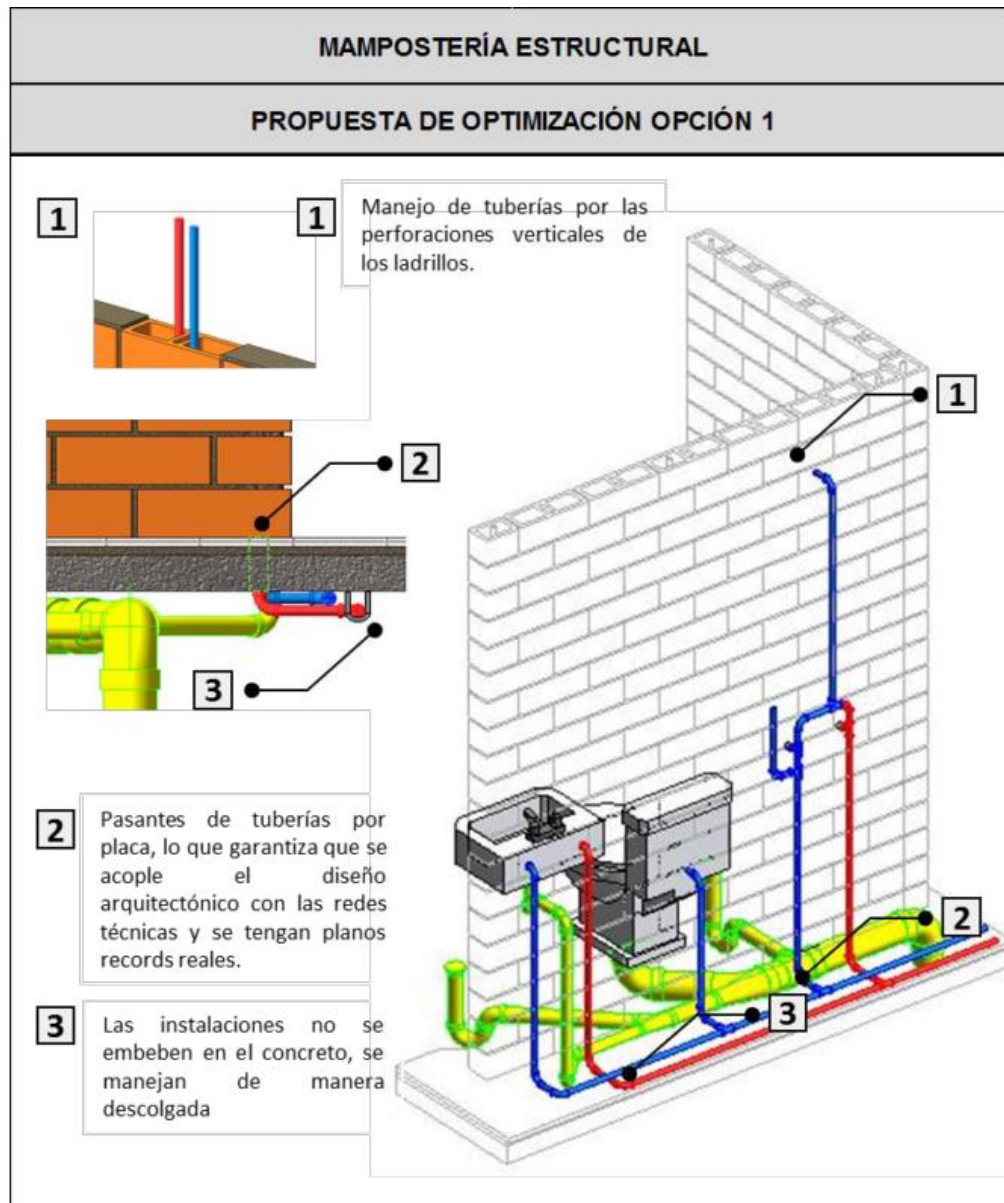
, Mampostería Estructural, Propuesta de optimización.
